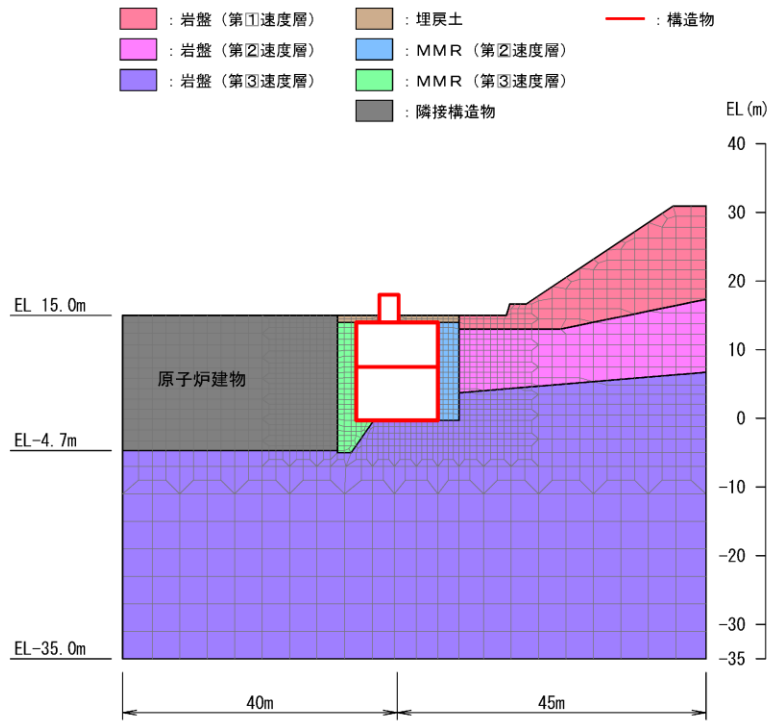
低圧原子炉代替注水ポンプ格納槽 地震応答解析モデル図 (A-A 断面)
